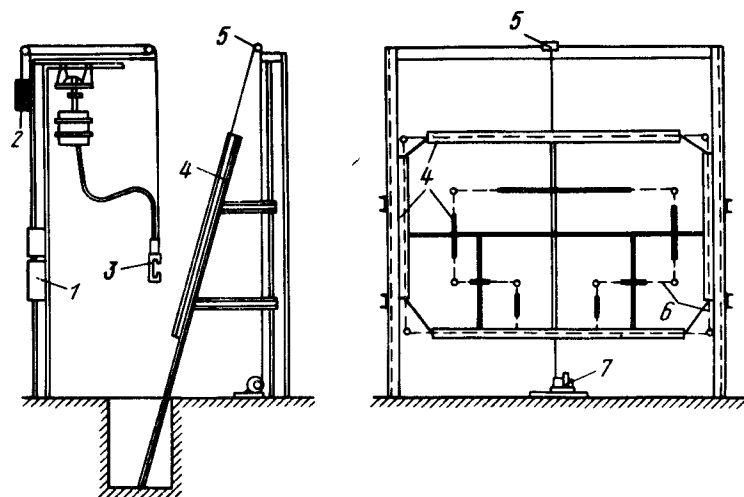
Кондуктор для сварки пространственных каркасов:
